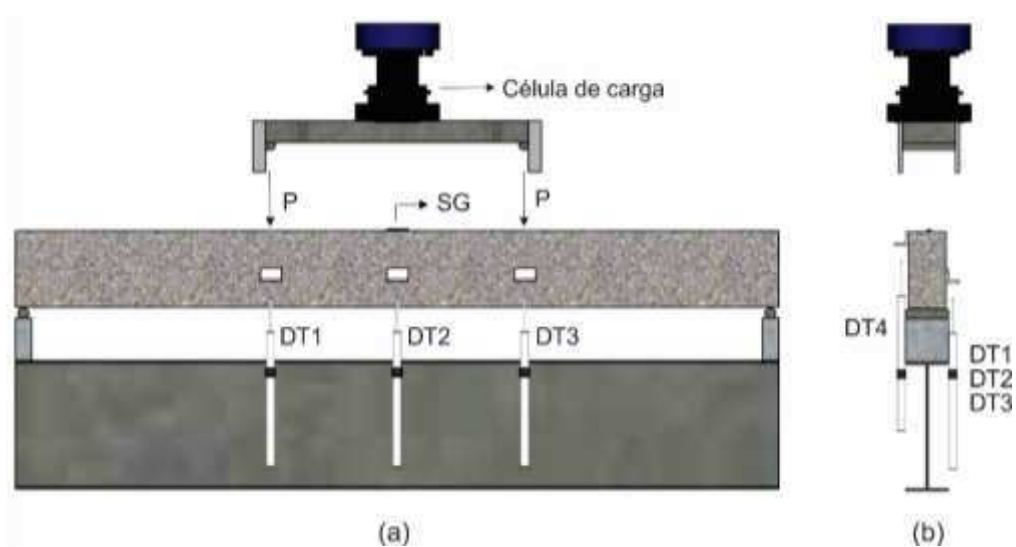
Montagem do ensaio de flexão: a) vista frontal; b) vista lateral.
